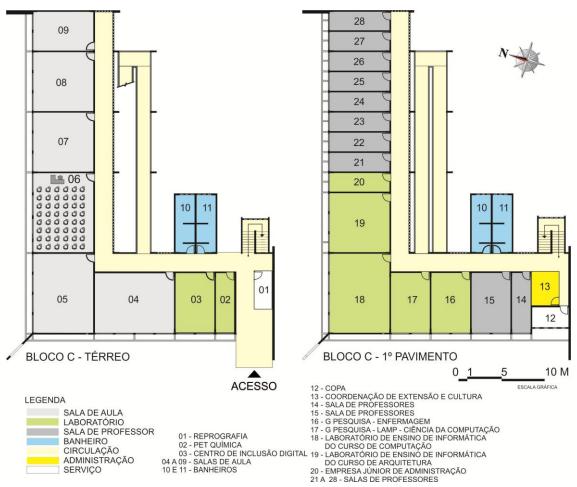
planta de usos do Bloco C – pavimento térreo e superior
